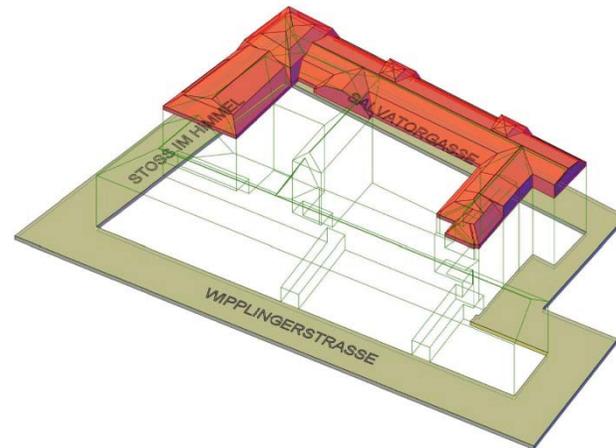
3D Übersicht Dachgeschoßbaus
